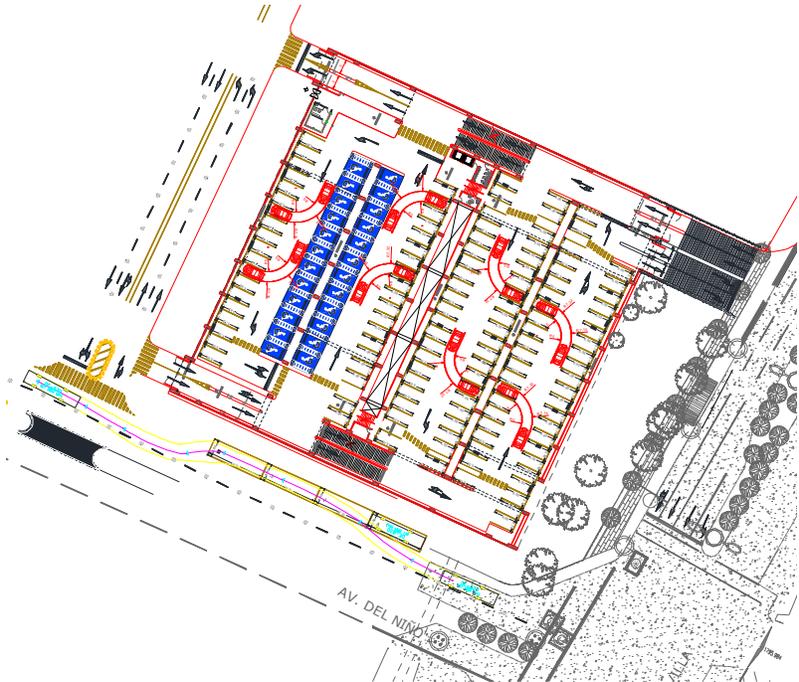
Planta Nivel 2. N+3.60 y N+5.40
